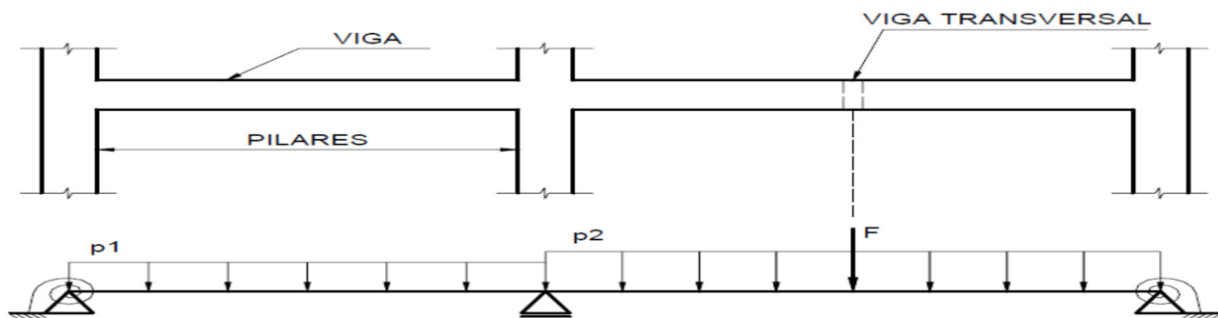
Esquema de uma viga (Fonte: Apointamentos de Edifícios)
